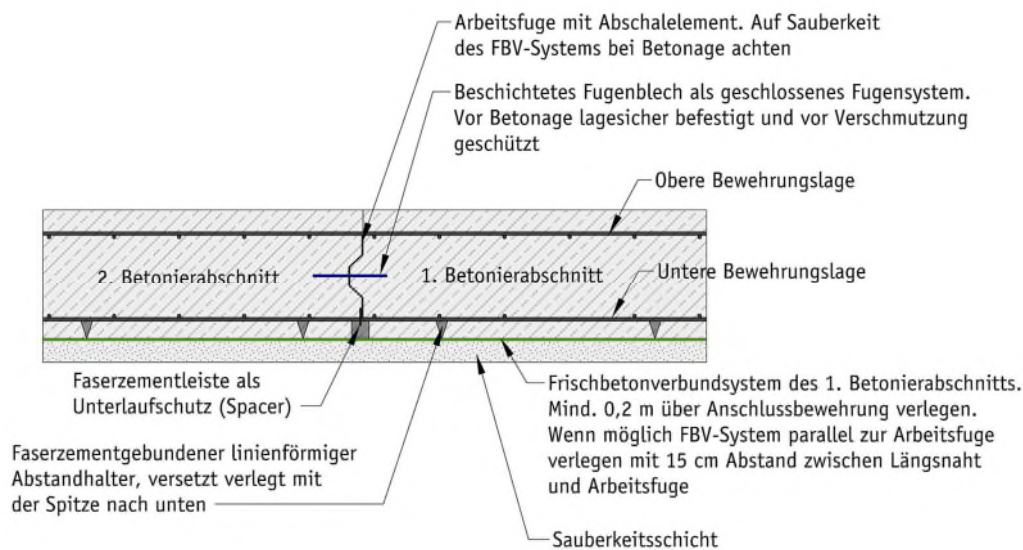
Leitdetail horizontale Arbeitsfuge mit Spacern und Streckmetallabstellungen zum Schutz vor auslaufendem Zementschlämme. Vertikale Arbeitsfugen sind sinngemäß auszuführen.
